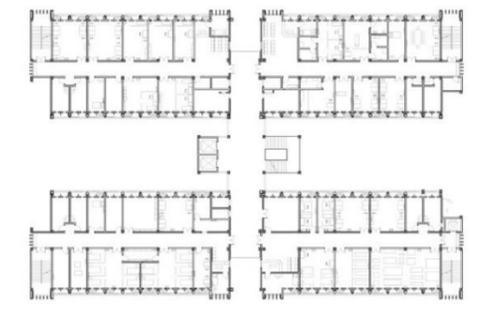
Deuxième plan d'étage du bâtiment de la technologie médicale, Source : Archdaily
